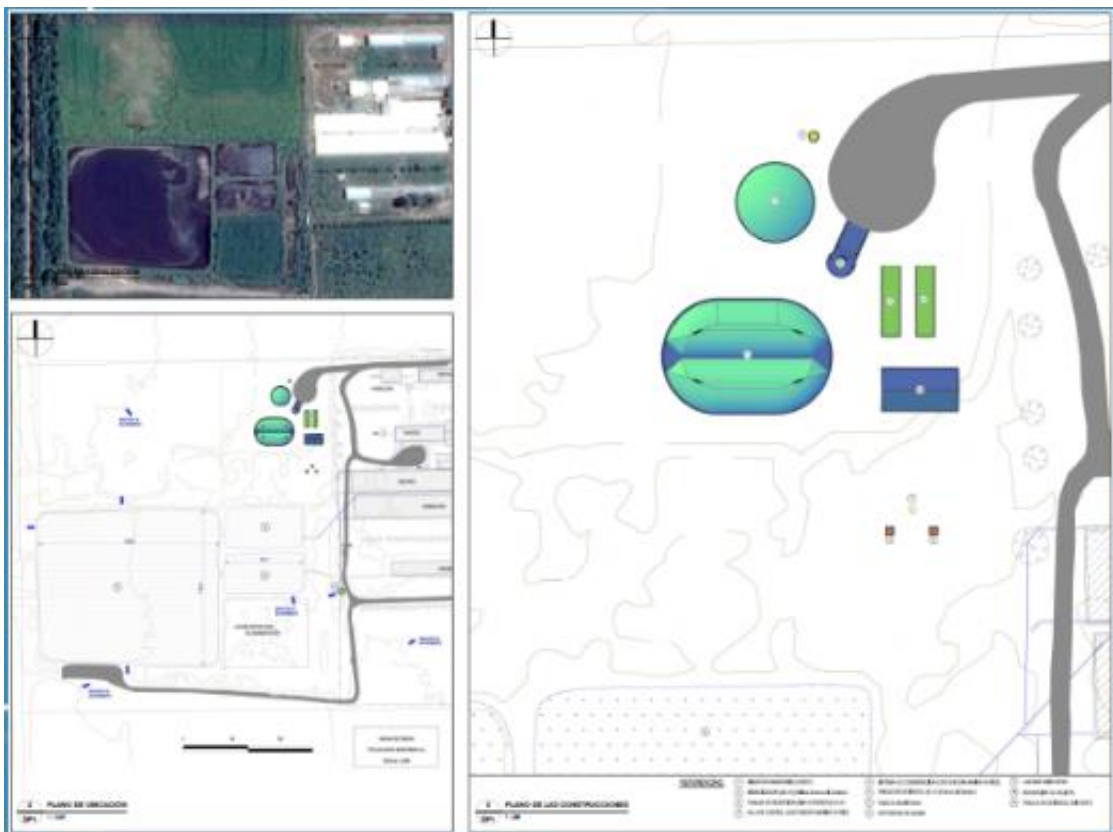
Plan de ubicación de la planta de biogás Villa del Rosario I.
